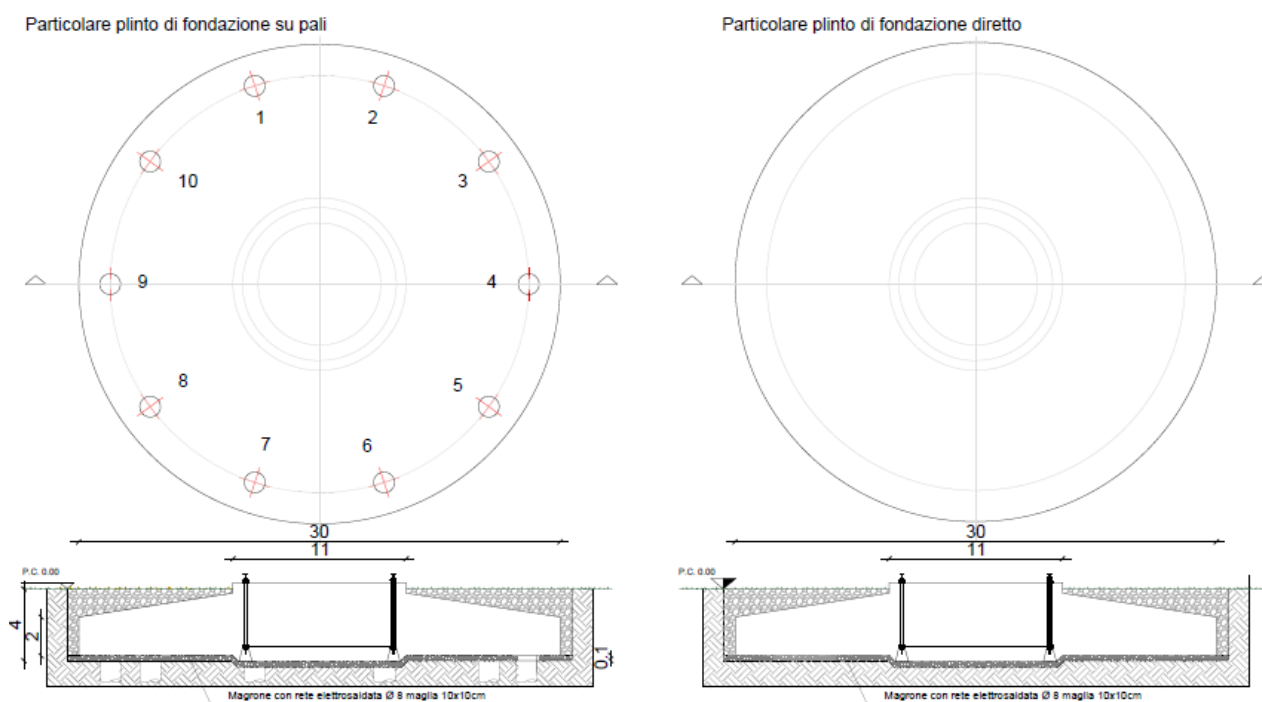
fondazioni tipo per l'installazione degli aerogeneratori
